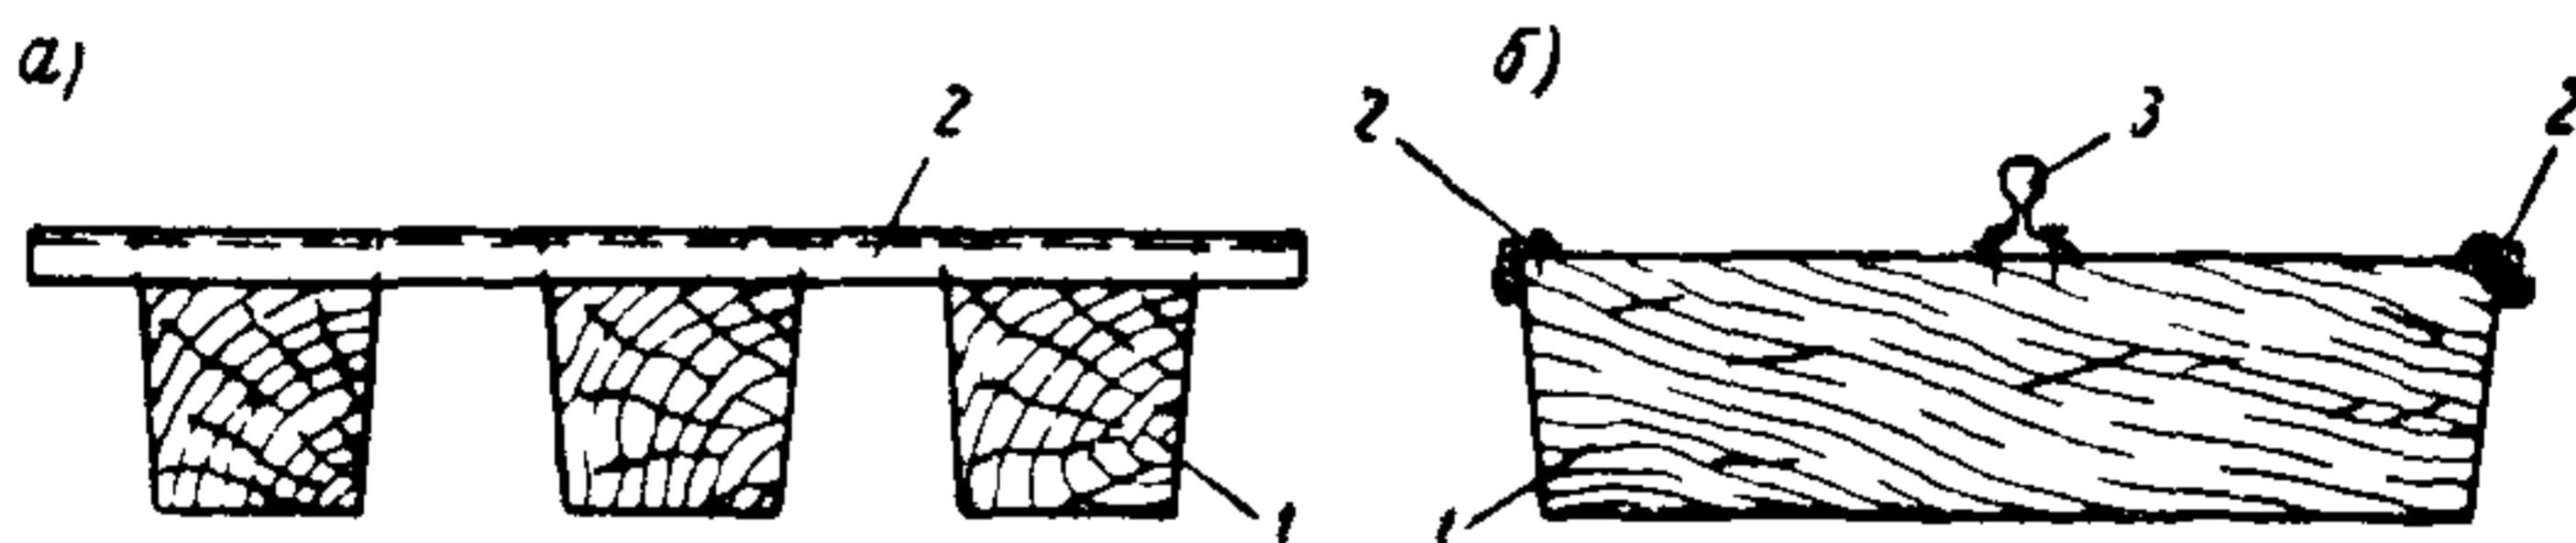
Поперечное (*a*) и продольное (*б*) сечения деревянных шпал с металлическими уголками
